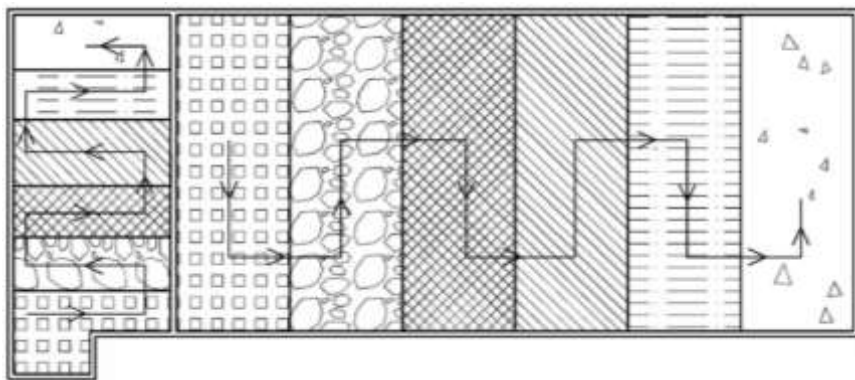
Технологическая схема производства работ при устройстве рулонной кровли:
